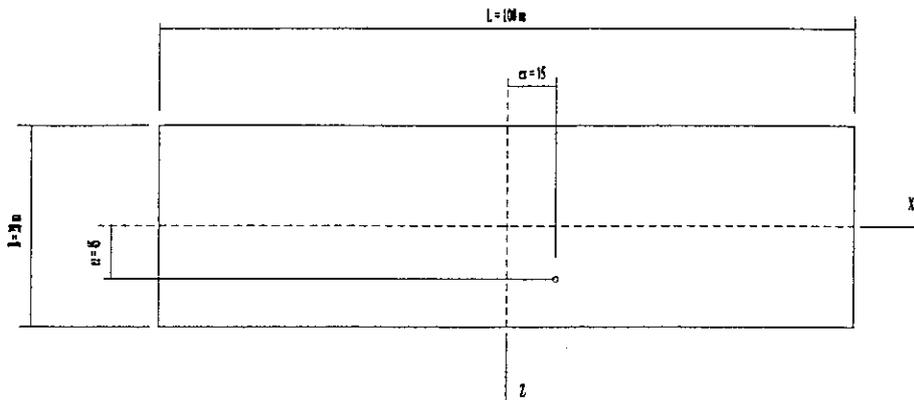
PLANTA DE CIMENTACIÓN
